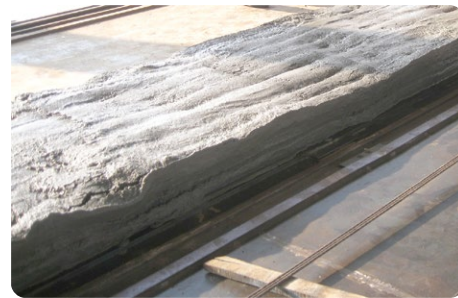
Пример разрушения круглопустотного бетона из-за неправильной консистенции
